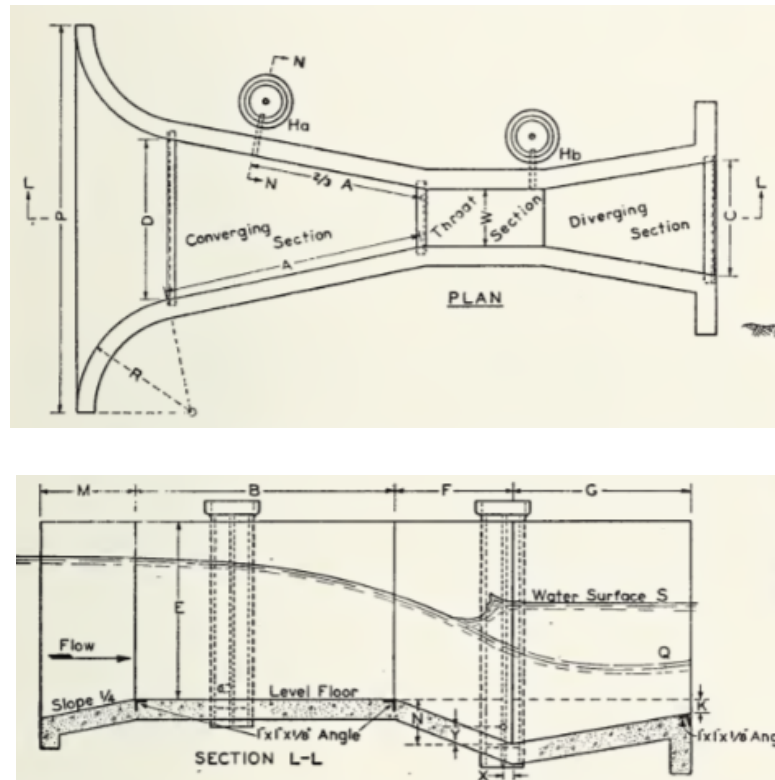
Calha Parshall convencional, vista superior e corte longitudinal
